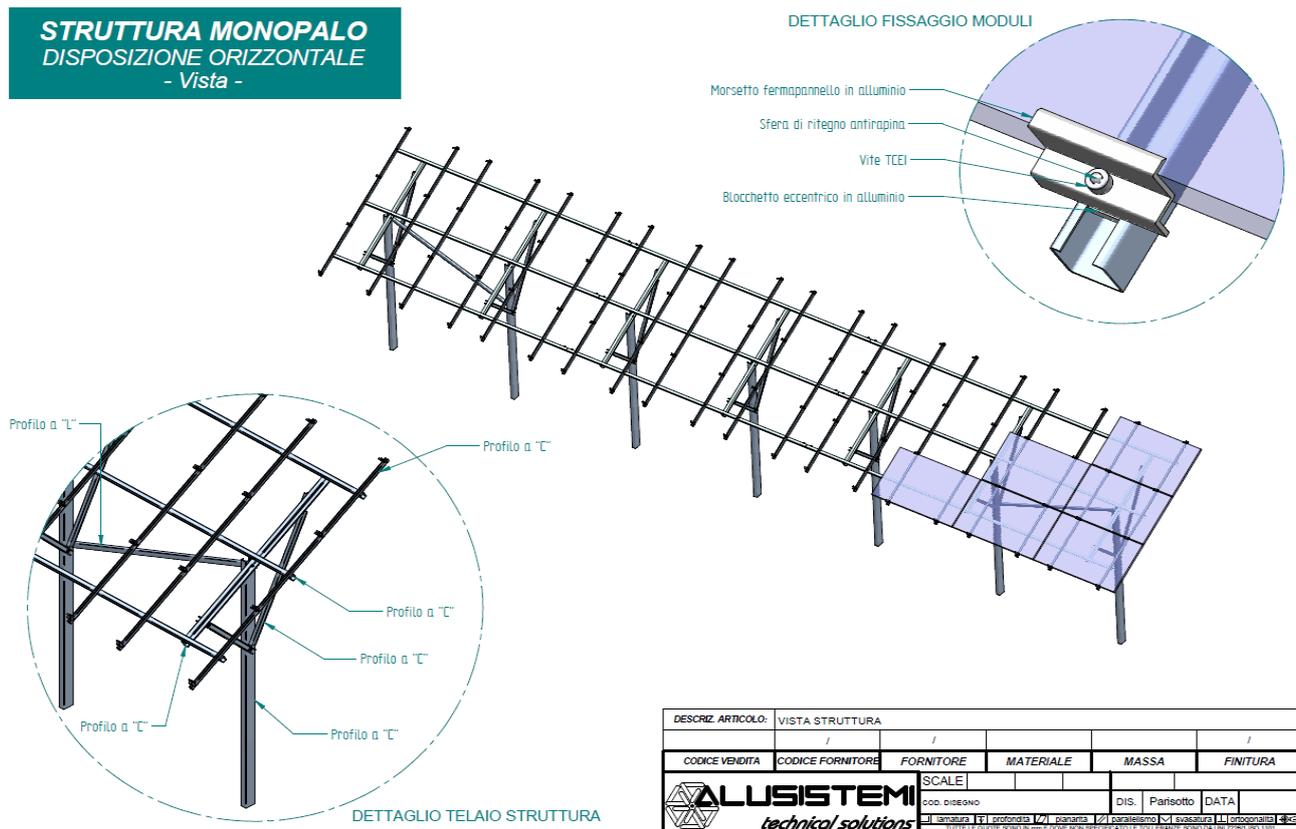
Particolare strutture di sostegno impianto del tipo fisso
